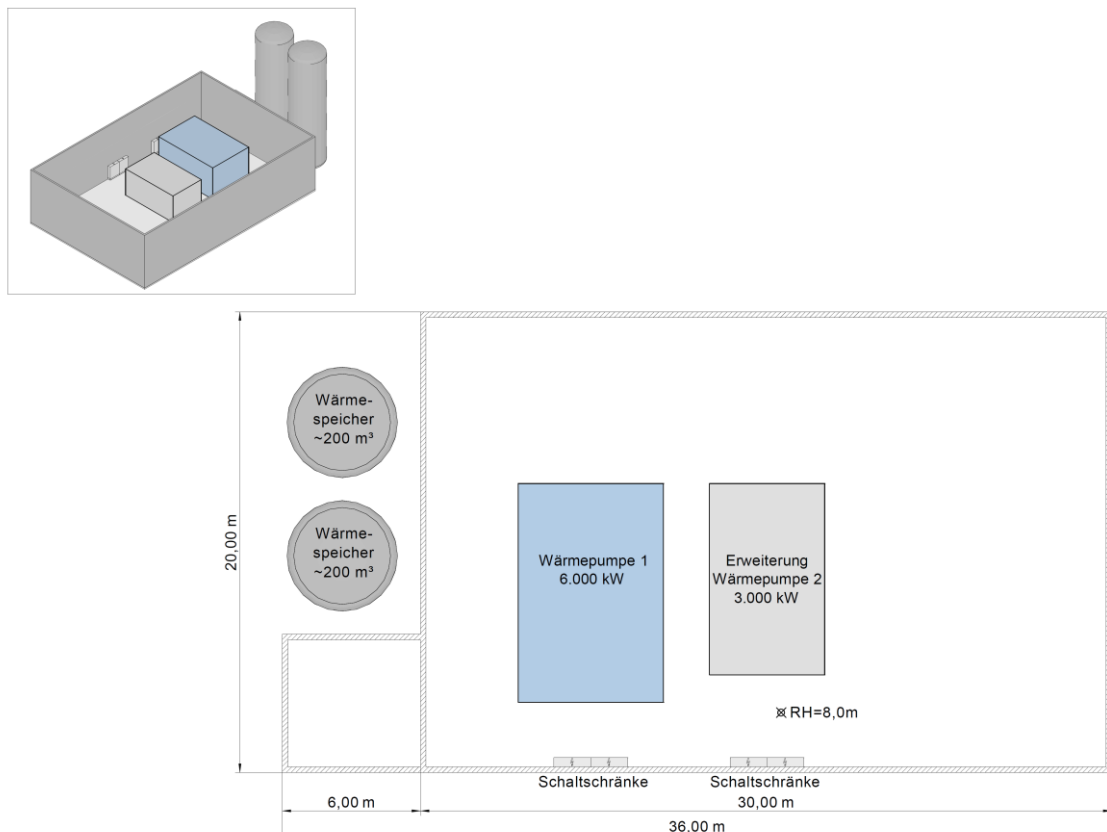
möglicher Grundriss Heizzentrale
